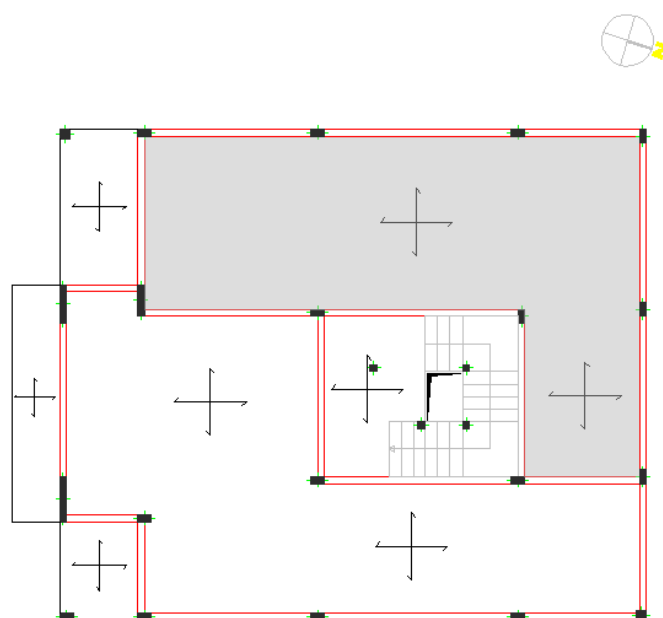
Elementos da estrutura do pavimento do piso 1
